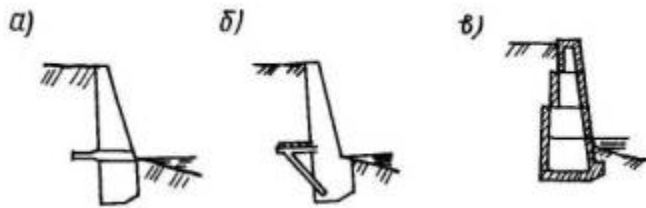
Сборно-монолитные откосоукрепительные стены и дамбы: а-с разгружающими устройствами в виде железобетонных плит; б-с разгружающей площадкой на кронштейнах; в-из пустотелых железобетонных блоков
